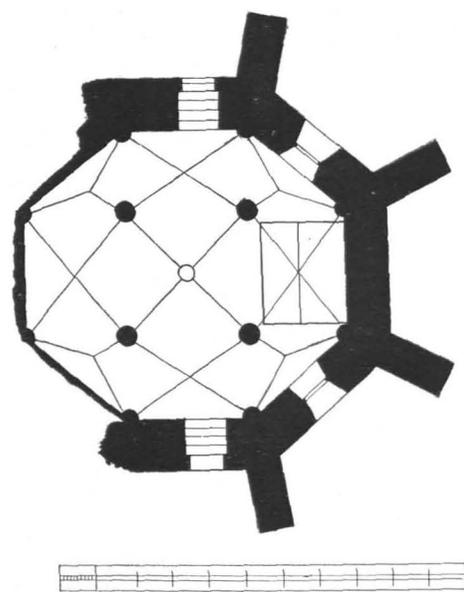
Seekirchen, Stiftskirche, Krypta, Grundriß 1:200 (S. 134)
